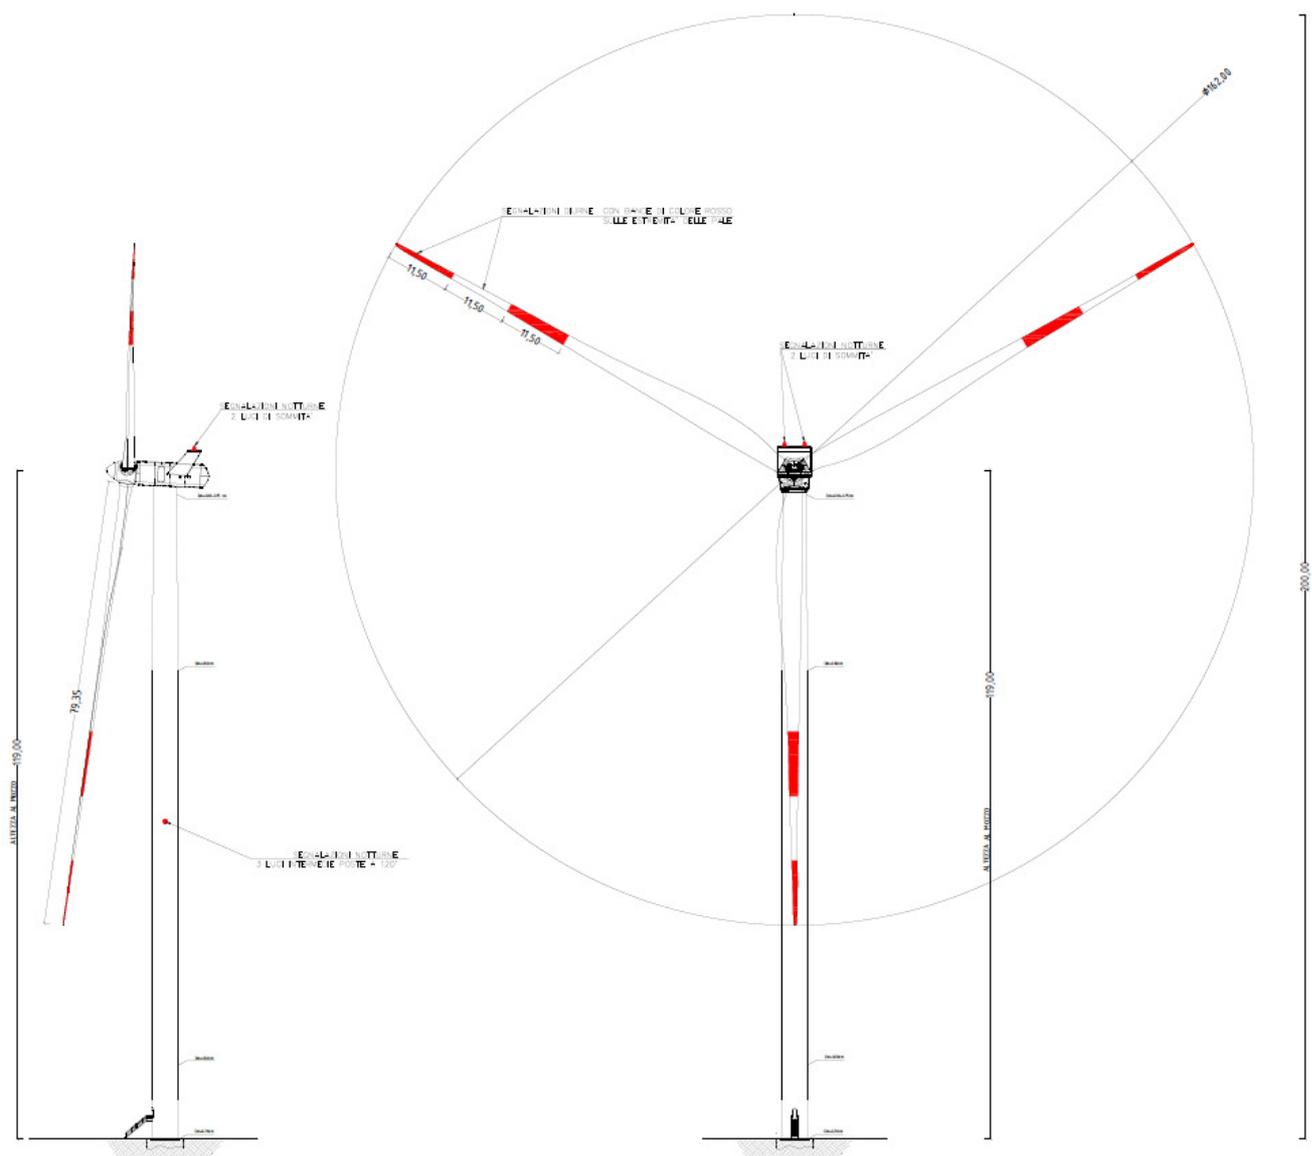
Prospetto e sezione dell'aerogeneratore tipo VESTAS – V162-6,2 MW
